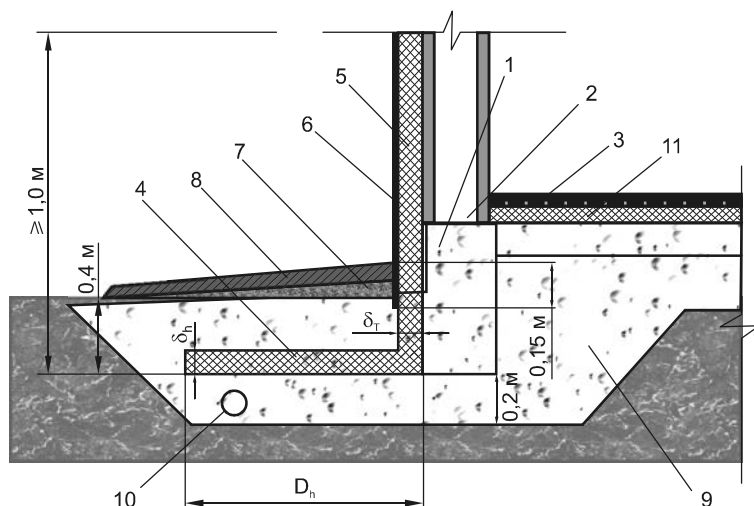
Схема укладки и параметры теплоизоляции в фундаментах отапливаемых зданий с теплоизоляцией пола: 1 — фундамент; 2 — стена здания; 3 — пол здания; 4 — горизонтальная теплоизоляция (KNAUF Therm® Floor / KNAUF Therm® 5 в 1 F); 5 — вертикальная теплоизоляция (KNAUF Therm® Floor / KNAUF Therm® 5 в 1 F); 6 — защитное покрытие; 7 — песчаная подготовка под отмостку; 8 — асфальтовая или бетонная отмостка; 9 — неупучинистый грунт; 10 — дренаж; 11 — теплоизоляция пола
